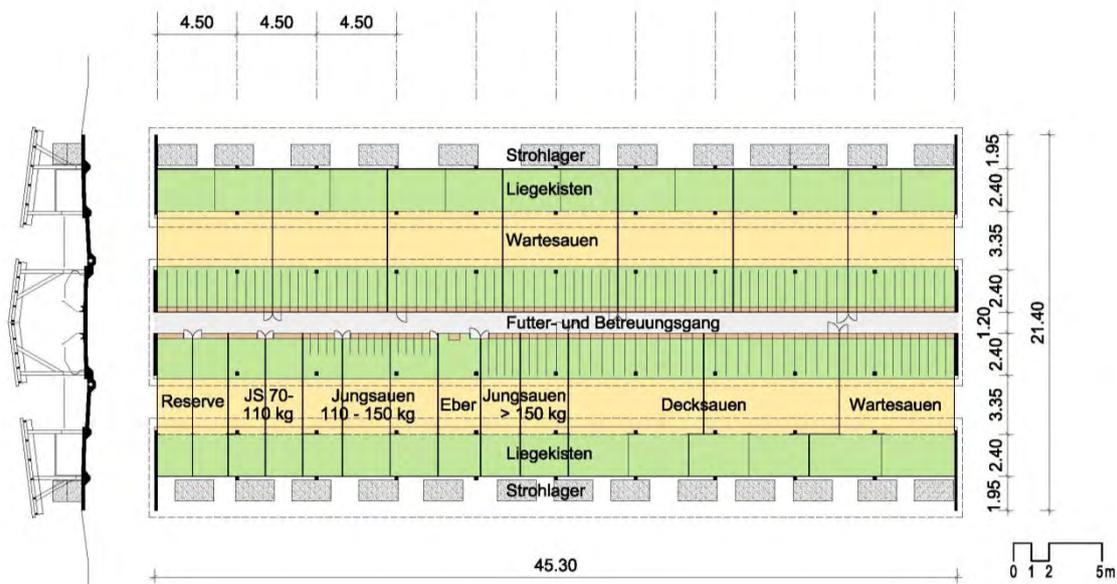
Grundriss und Schnitt des Deck-/ Wartestalls MODEL I
